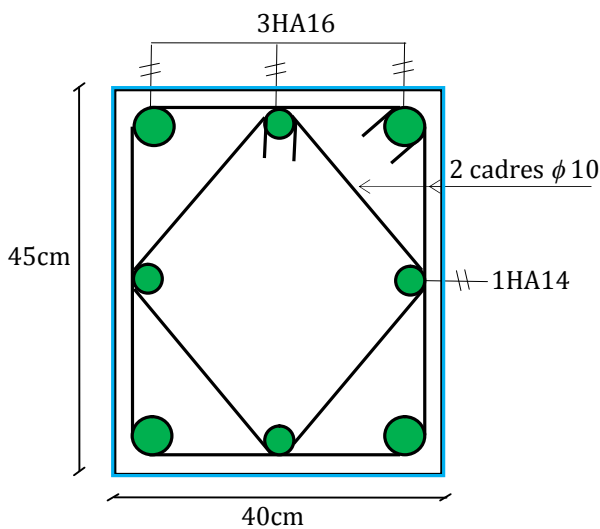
Schéma de ferrailage des poteaux 5^{eme}, 6^{eme}, 7^{eme} et 8^{eme} étage.
